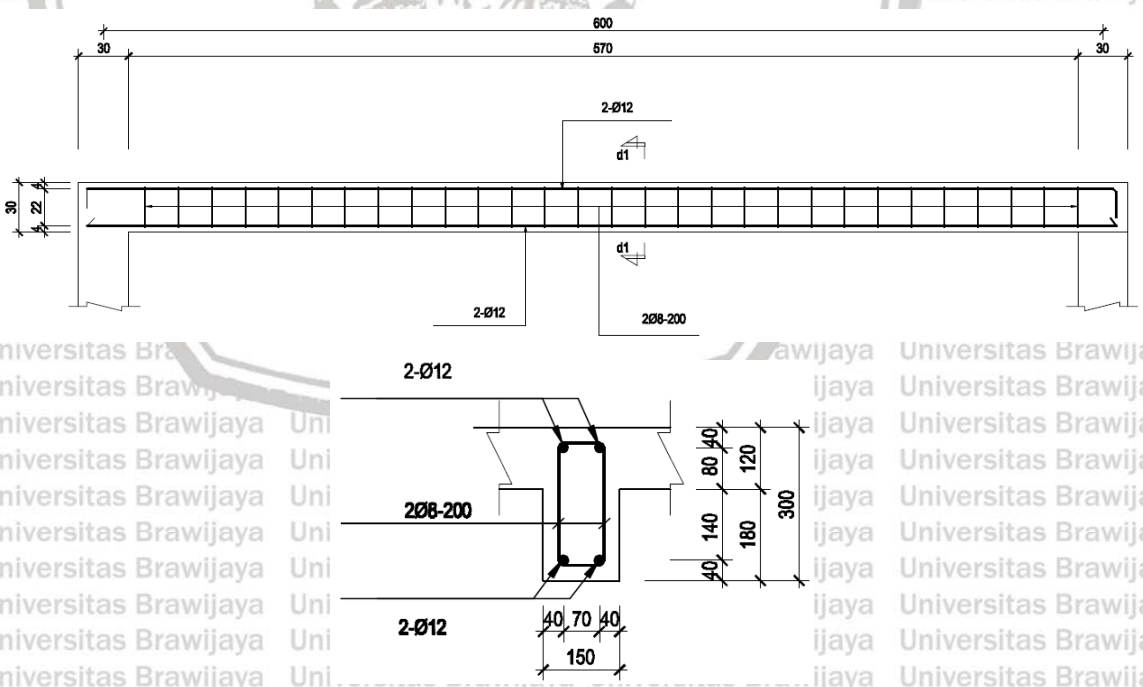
Denah Balok Lantai 5 dan 6.
